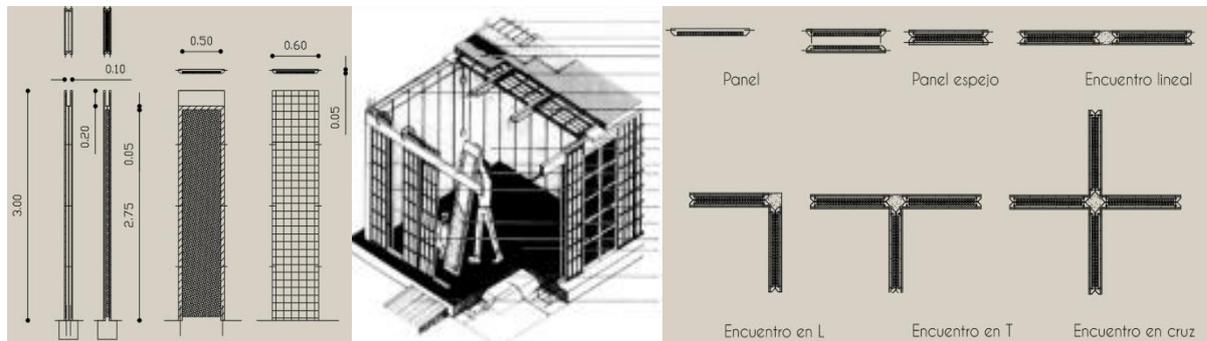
Sistema constructivo de paneles prefabricados de hormigón alivianado. Fuente: equipo de alumnos Sotelo y Tosi, 2016.
